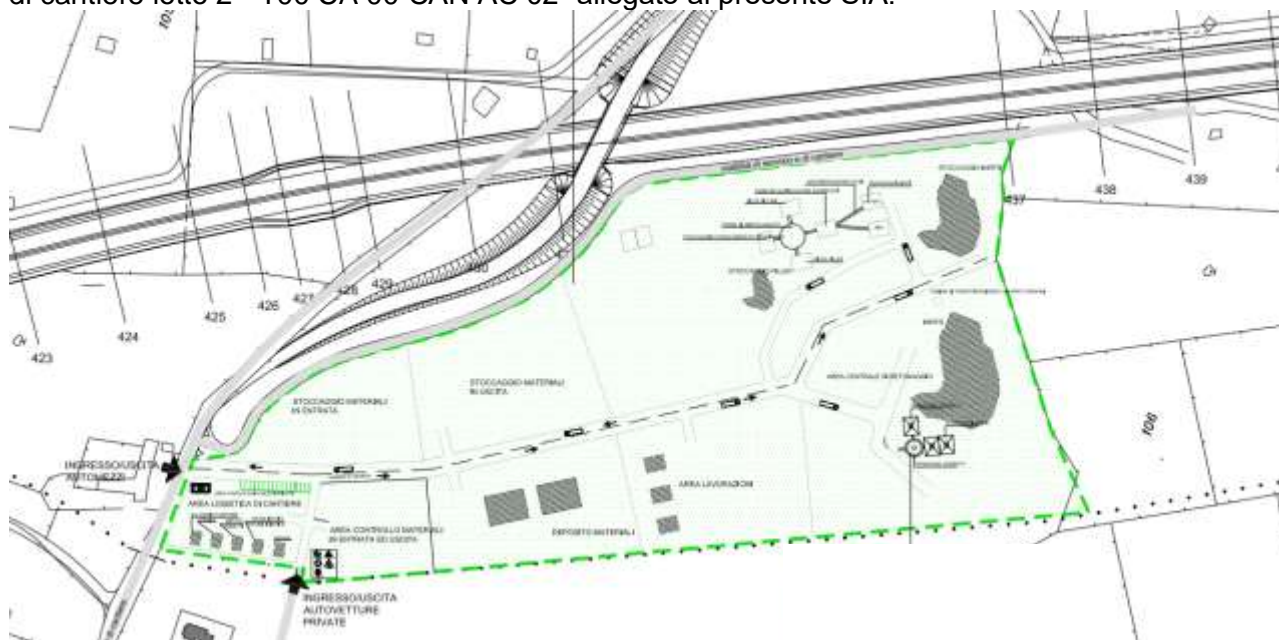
Area di cantiere 2 – PD 2005 - Dettaglio
